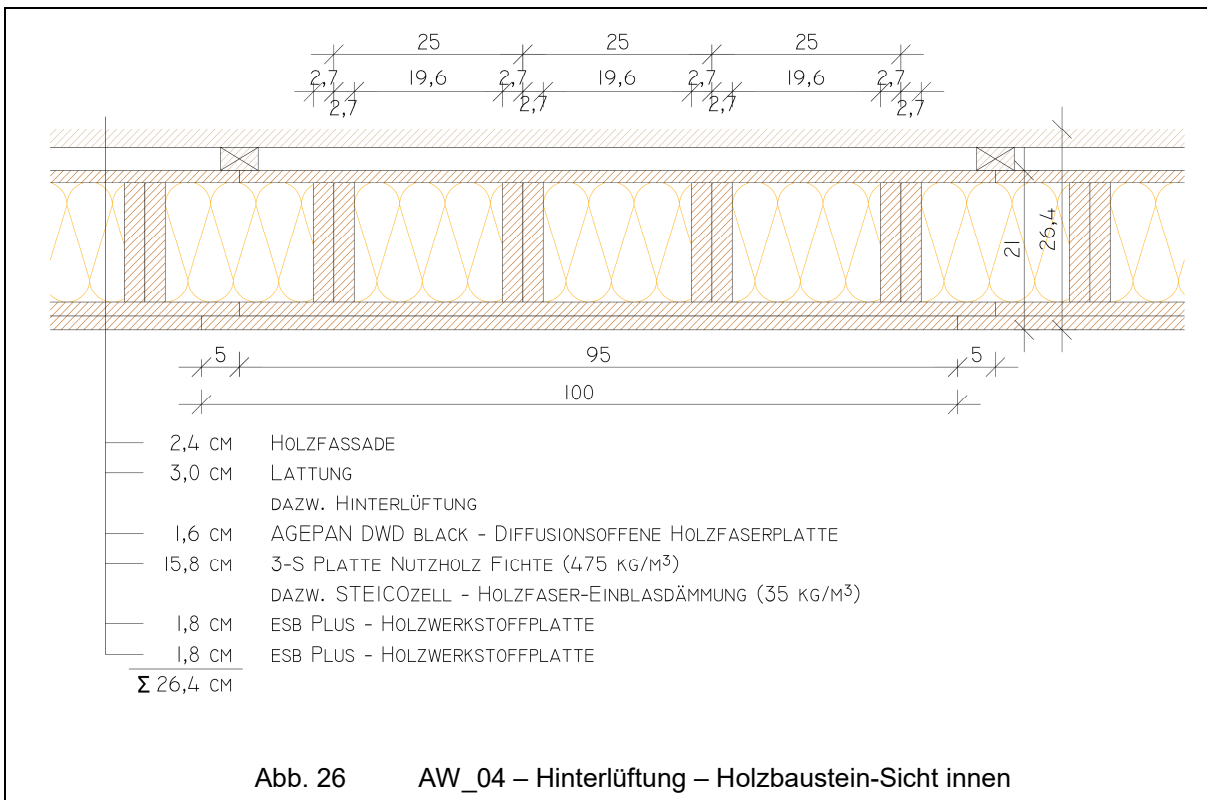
AW\_04 – Hinterlüftung – Holzbaustein-Sicht innen
